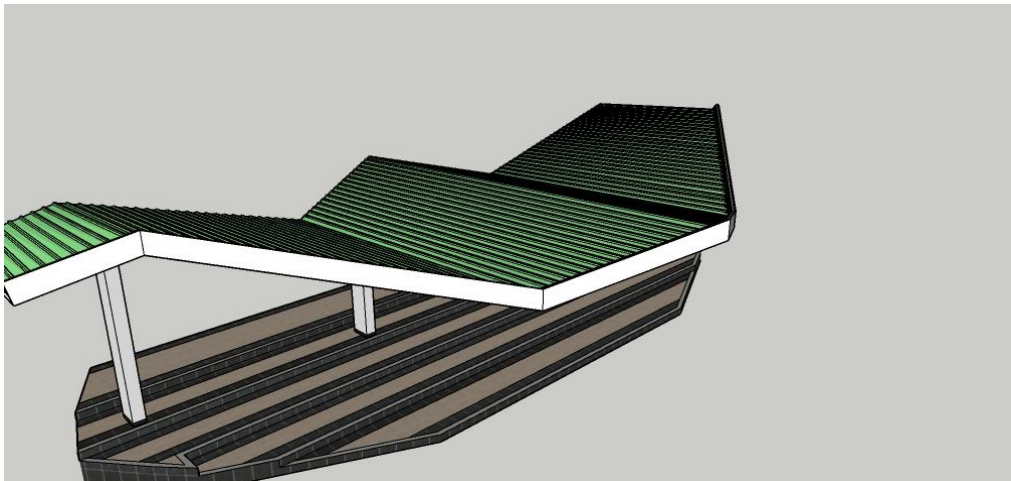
Modelo 3D Cubierta Campo de Parada vista isométrica.
